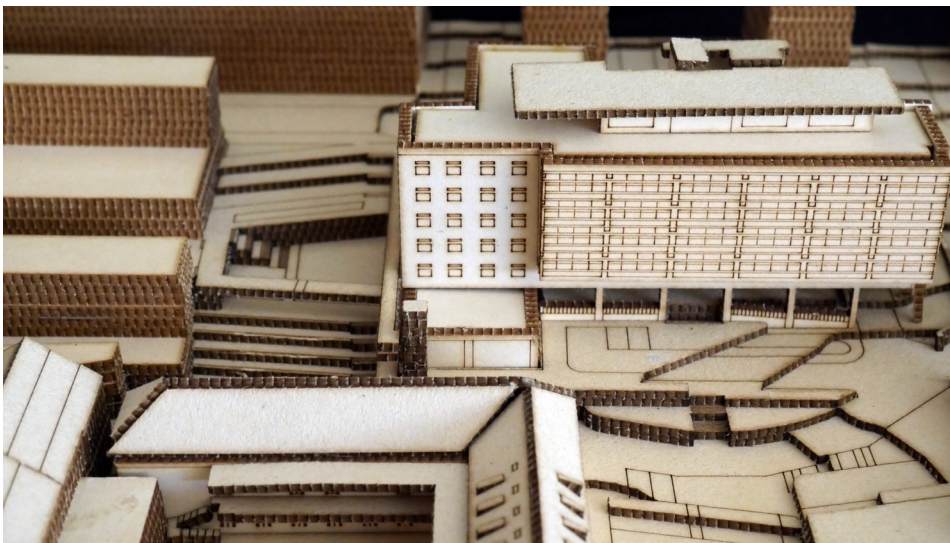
Maquete 1/500 do conjunto arquitectónico.
